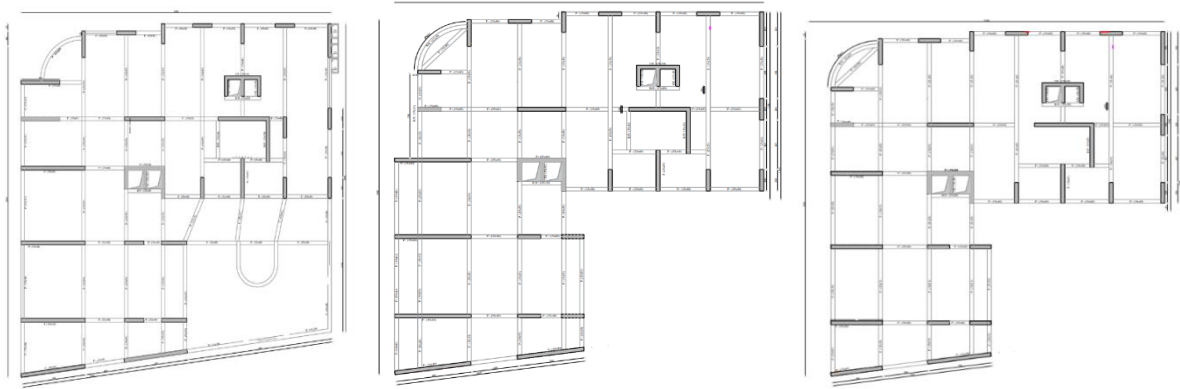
Variantes en plan de la structure (Cas 1, Cas 2 et Cas 3).
